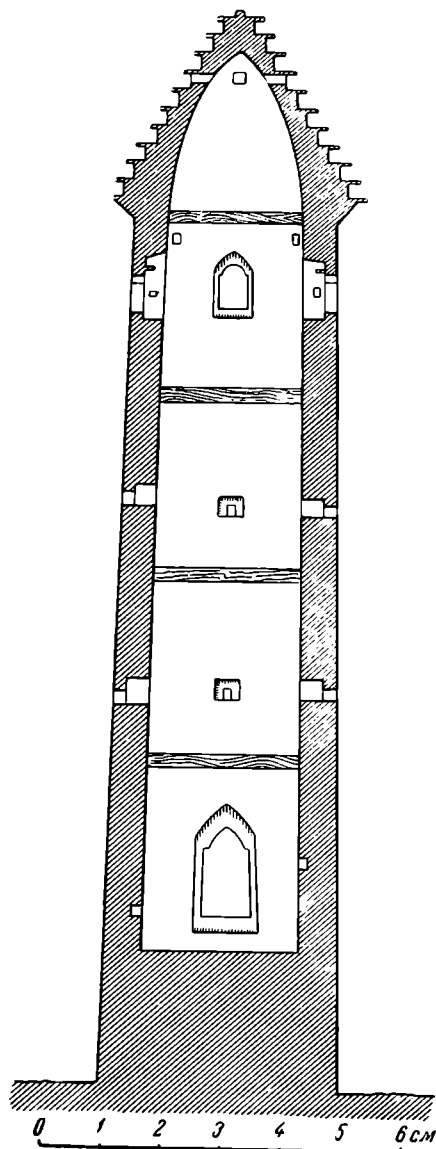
Замок Анапури. Разрез башни с пирамидальным перекрытием.
